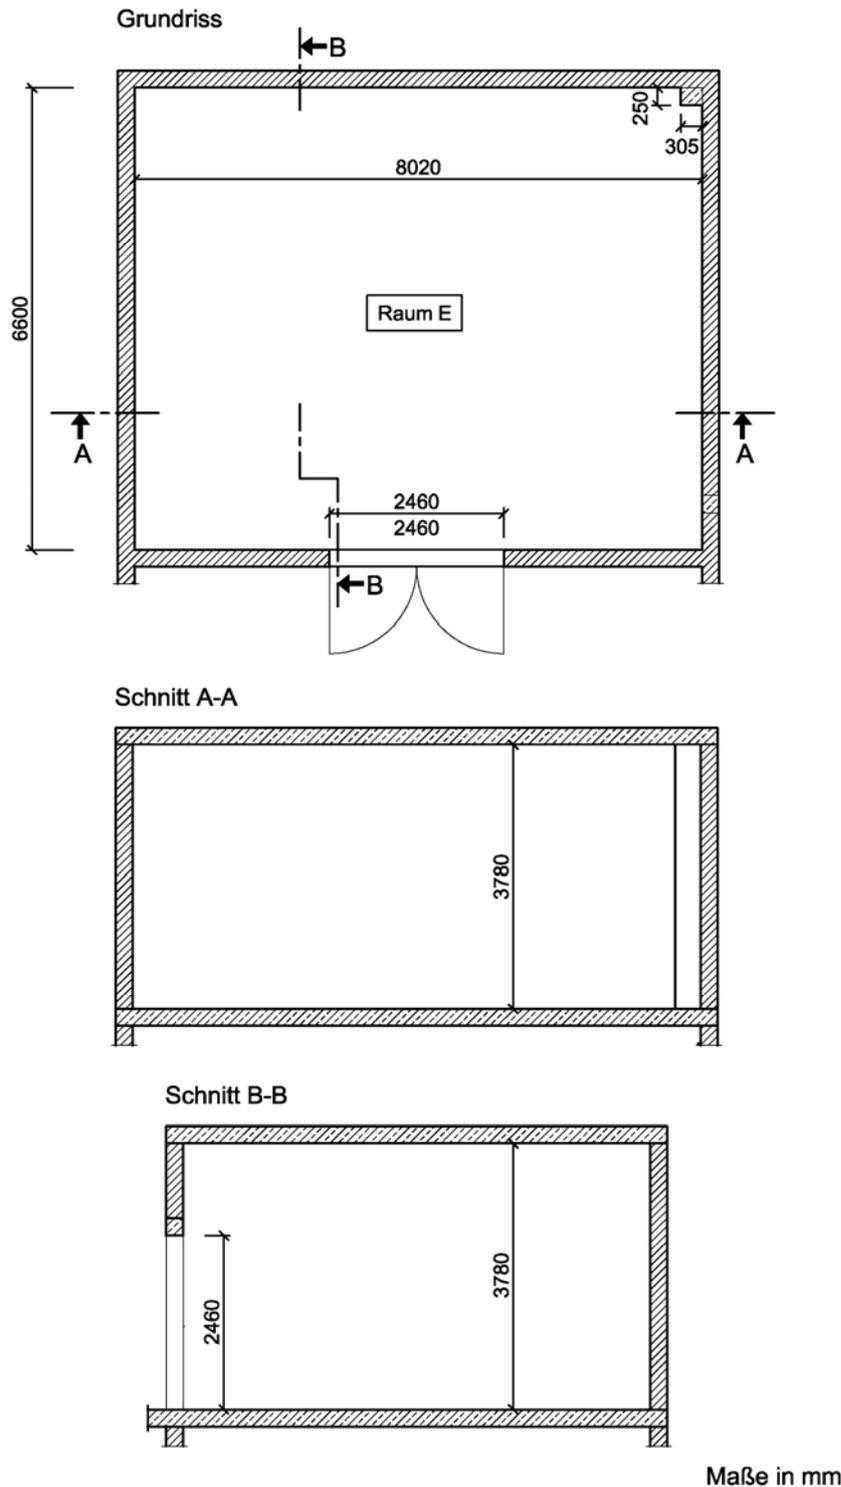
Grundriss und Schnitte des Hallraums.
